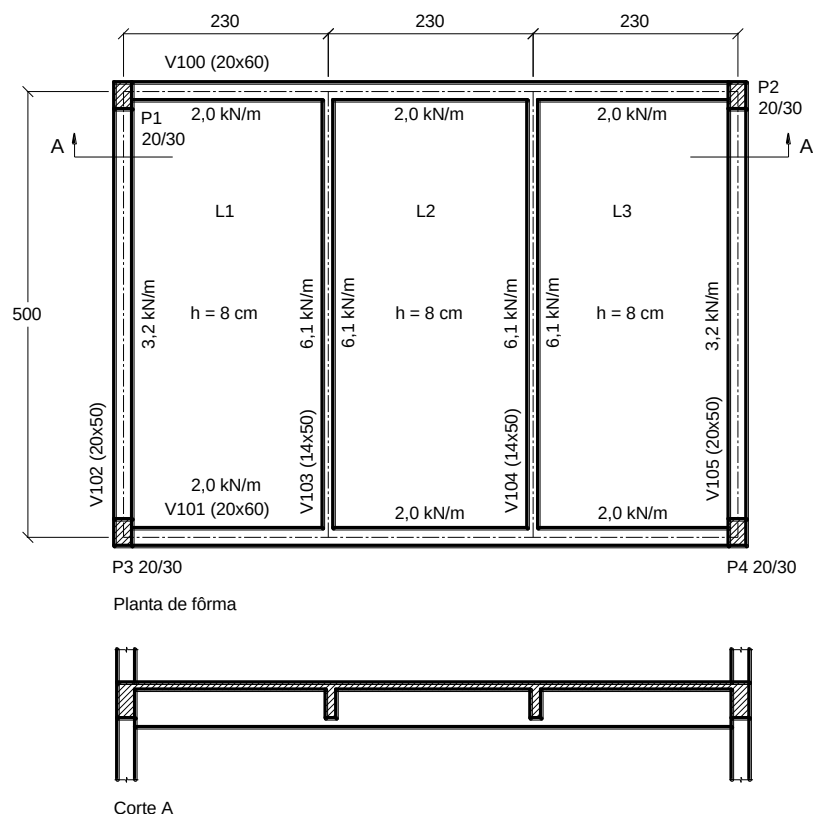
Planta de fôrma do pavimento (medidas em cm).
